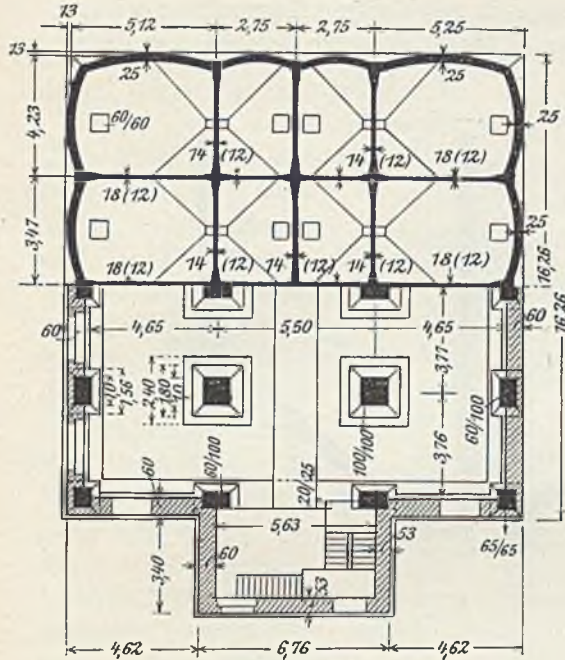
Grundrisse. Getreidesilo Worms.
